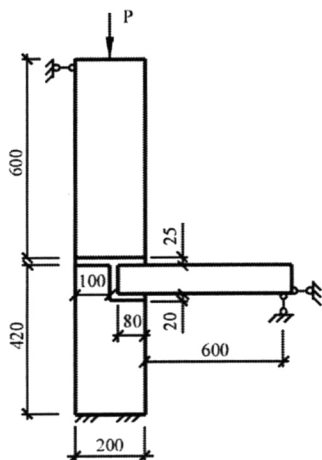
Схема приложения нагрузки и образец, смонтированный на прессе ИПС-200 (показаны размеры базового образца)
